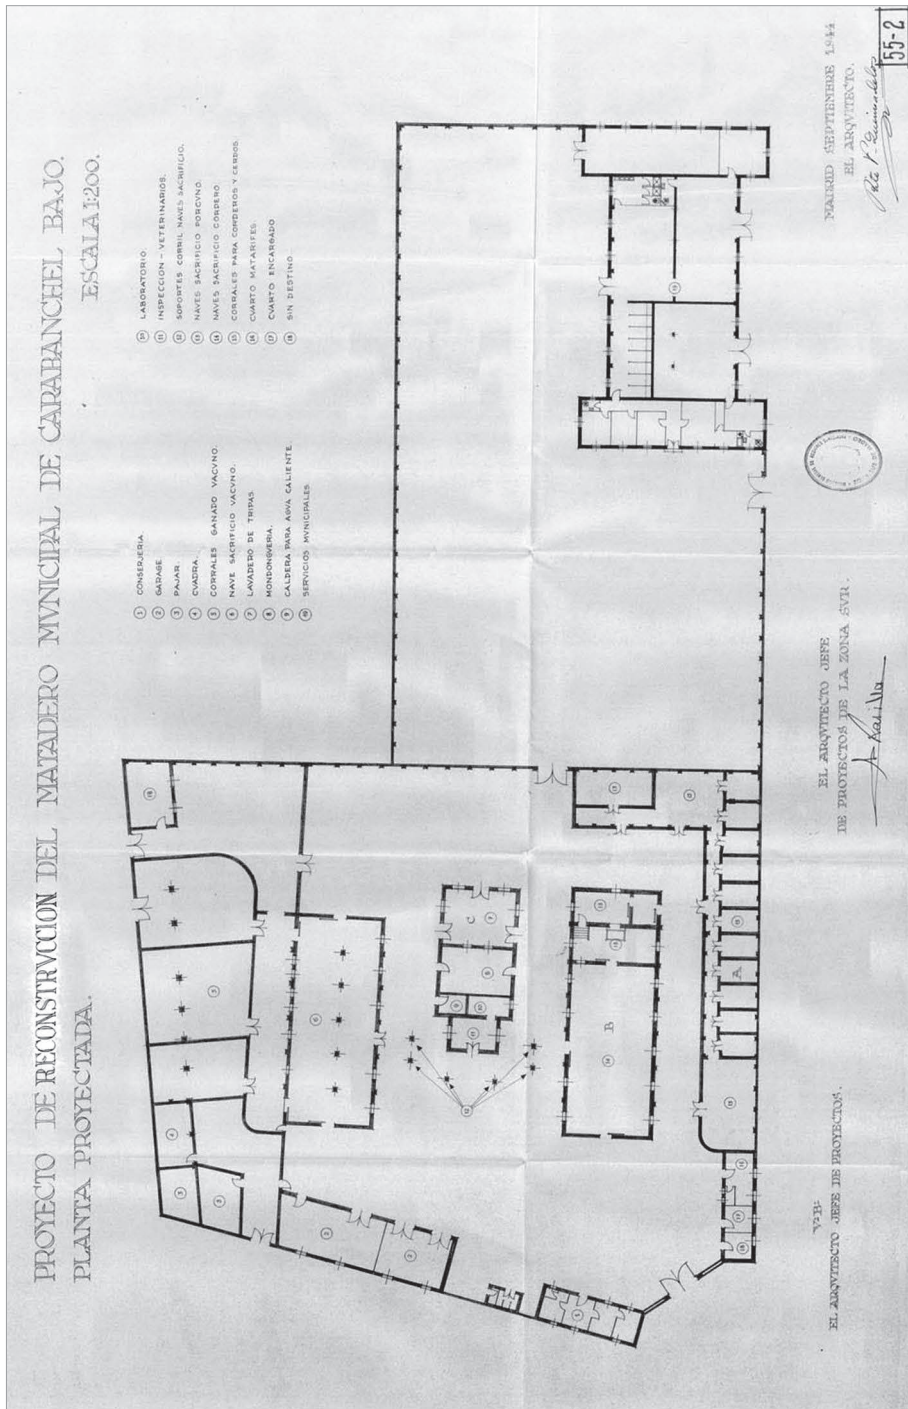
Matadero Municipal y Lavadero. Carabanchel Bajo. Propuesta. Planta de conjunto, 1944. AGA, (2) 81.03 2577 Top 76/04.
